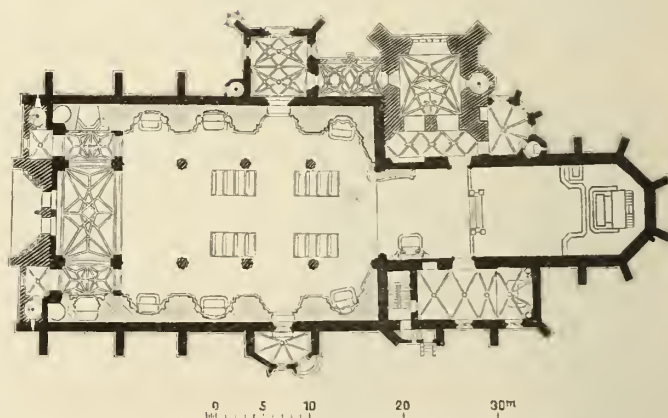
Grundriß. Entwurf des Regierungs-Baumeisters
